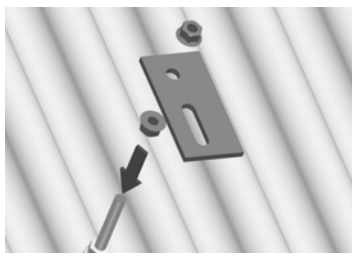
Profilschienerhalterbefestigung mit Stockschraube für Wellplatten
